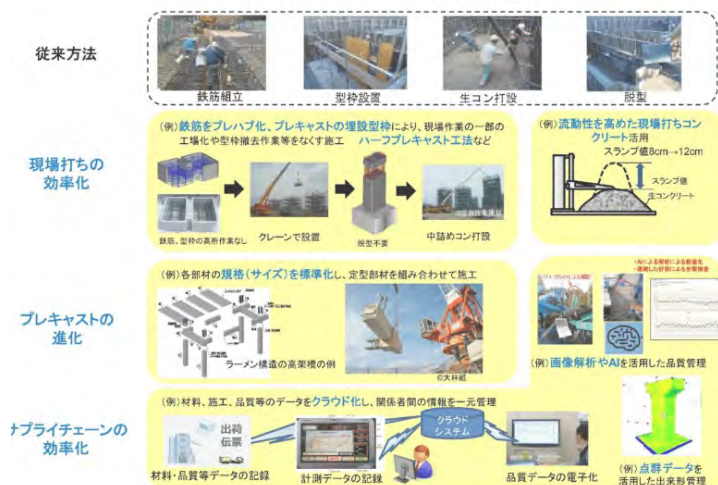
i-Construction (コンクリート工) が目指す建設現場のイメージ
